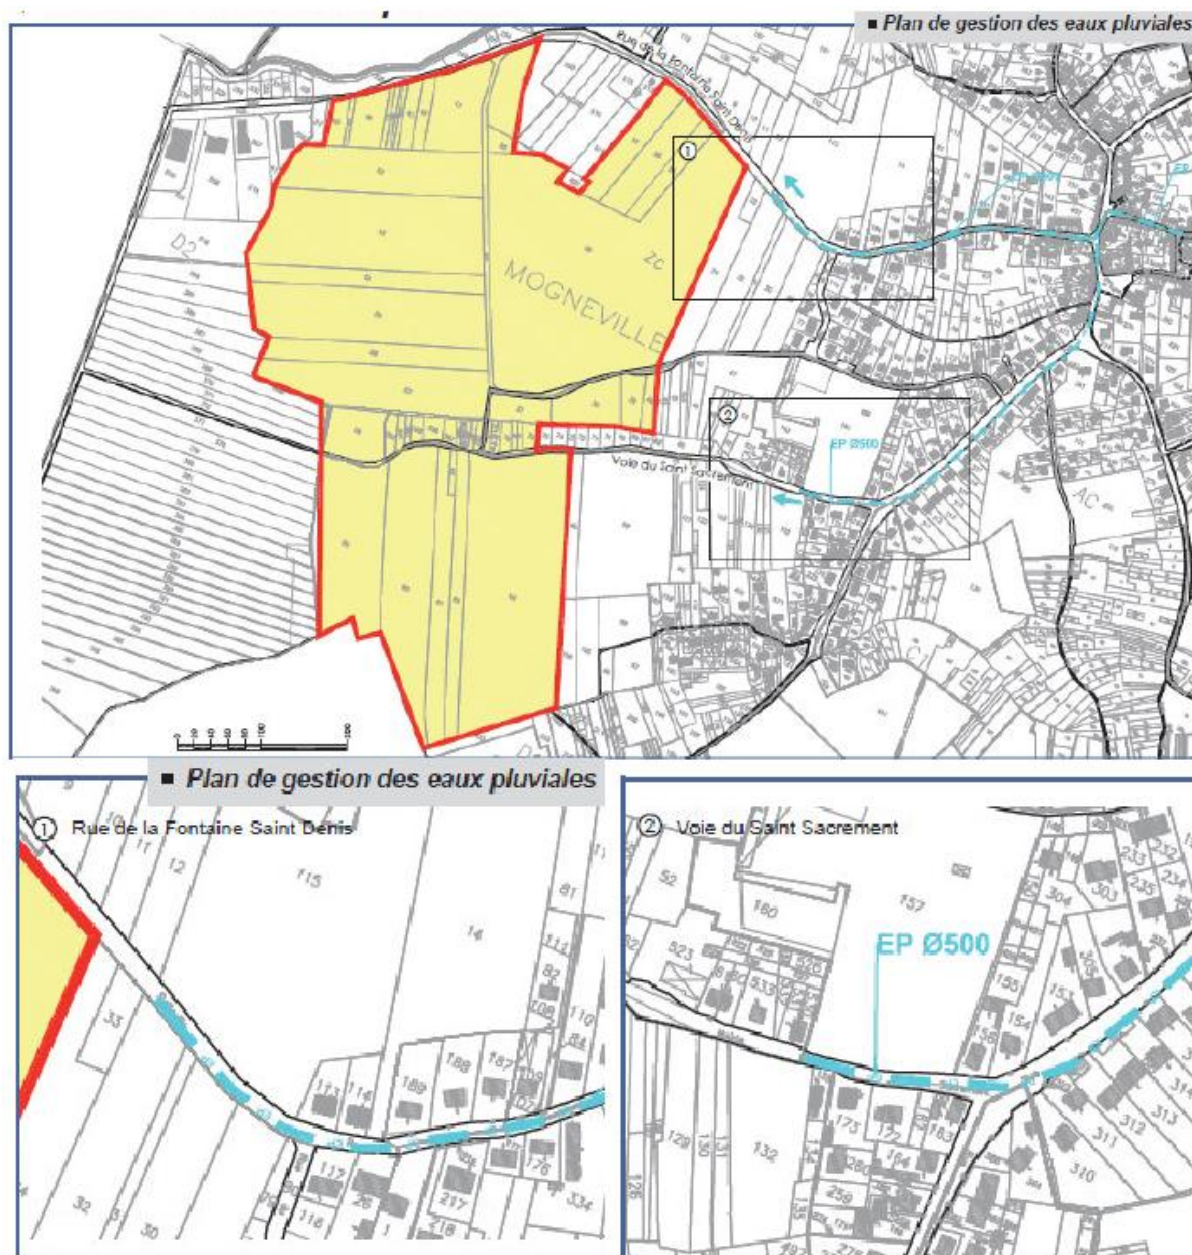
Plan de gestion des eaux pluviales (cabinet Greuzat)
